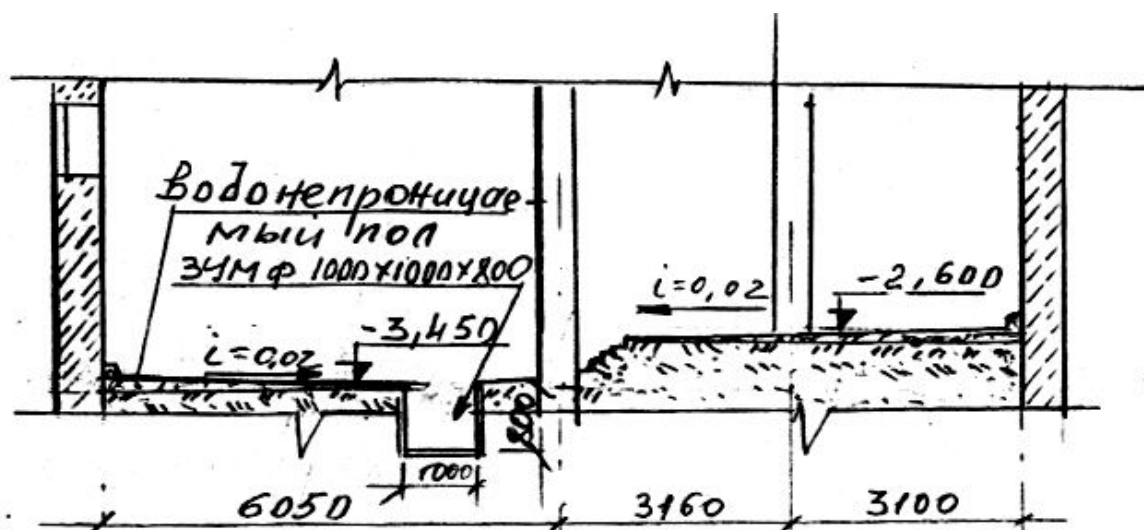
Схема устройства водонепроницаемых полов из бетона в подвальной части здания
